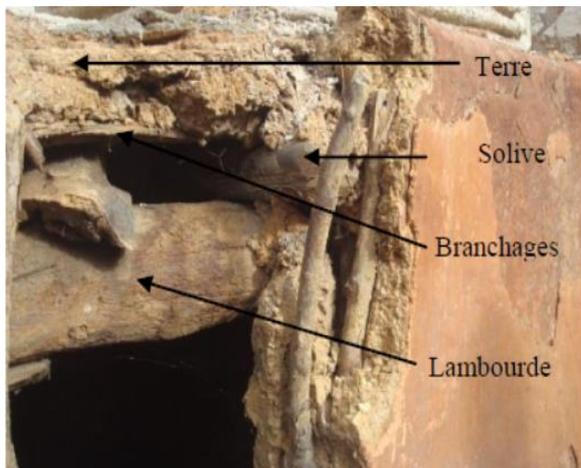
Différentes strates existant sur les planchers.(source :Kaci Mebarek.Op.cite.p100)
